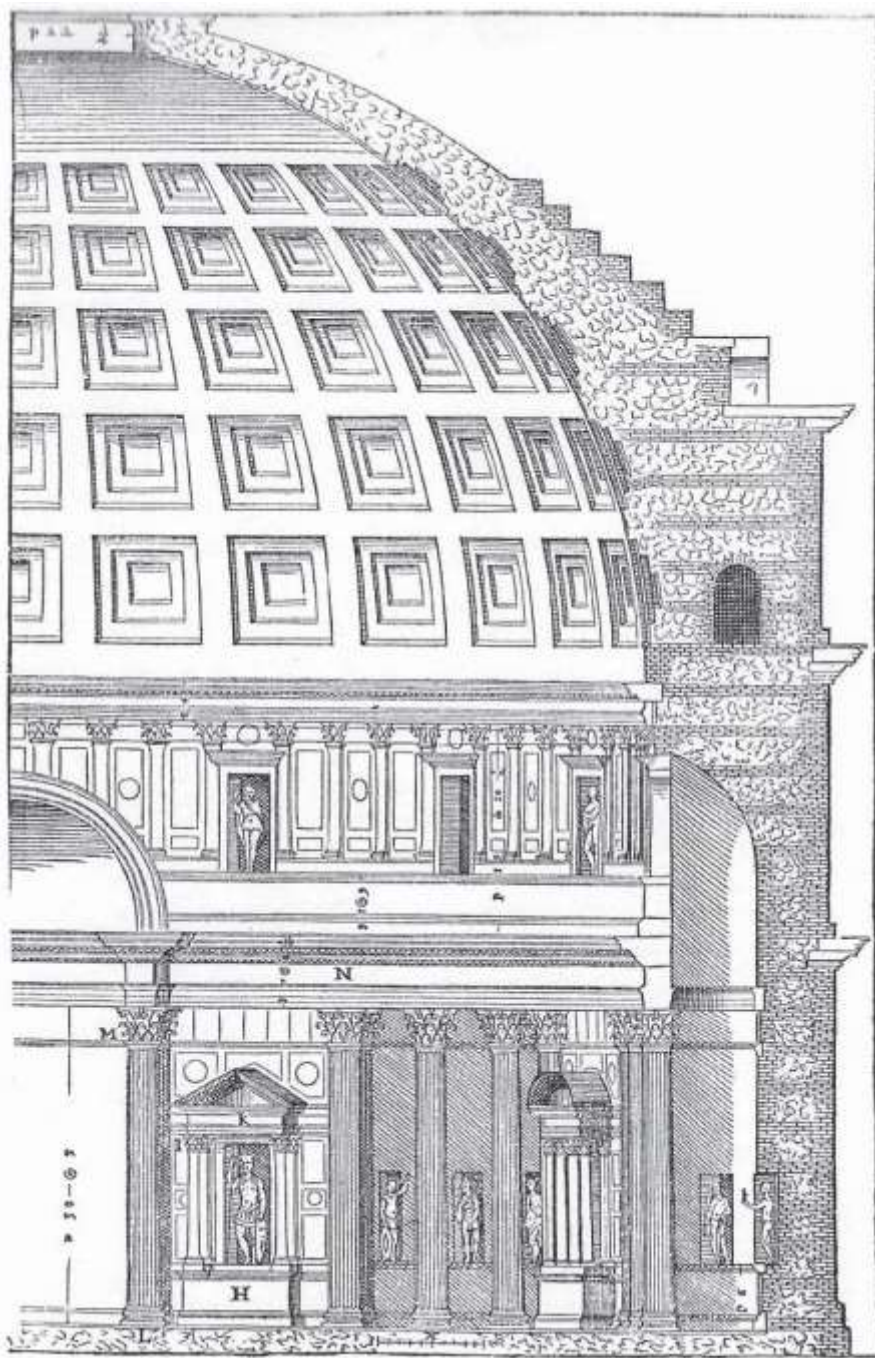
Sezione e Pianta del Pantheon - Andrea Palladio, 1570.
